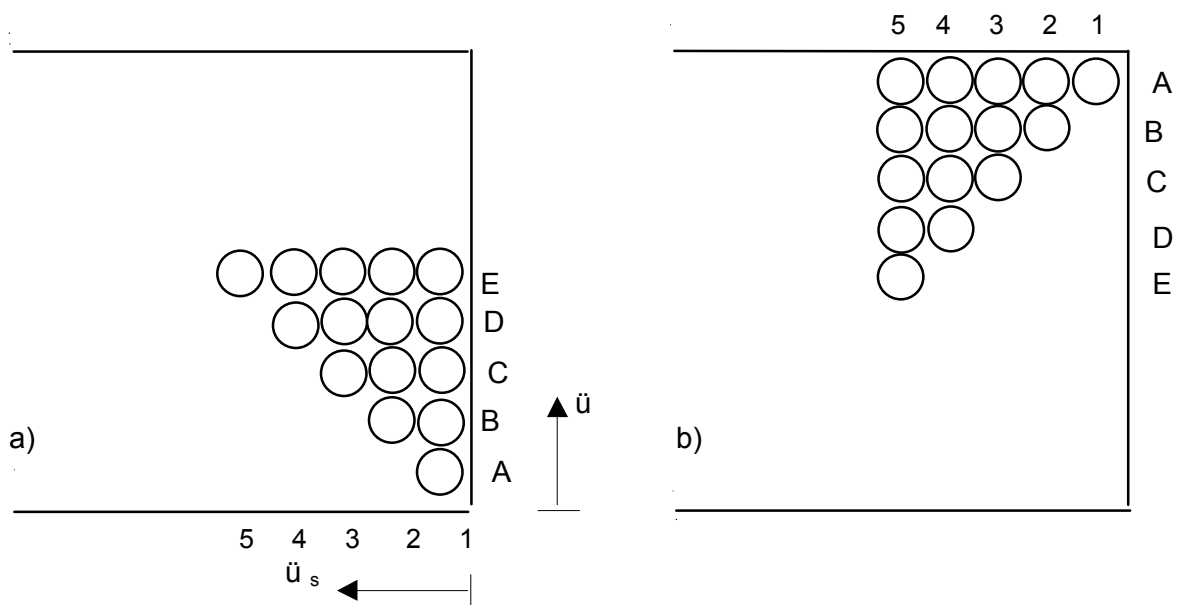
Schematischer Grundriss des nicht gelagerten Eckbereiches mit eingezeichneten Lochstellen und Achsenbezeichnung, nicht maßstäblich
